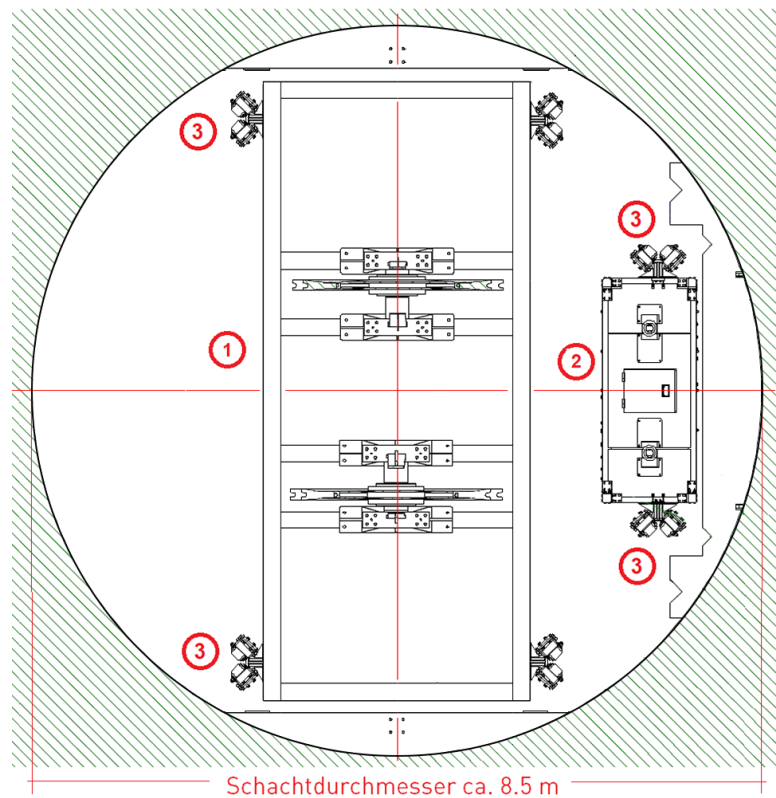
Schachtscheibe (Grundriss) eines beispielhaften Zugangsschachts
